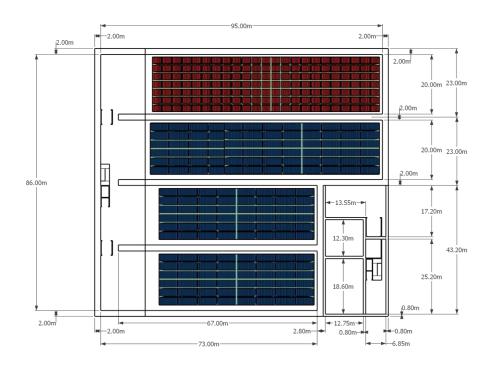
7 m³ 鋼箱及 20 呎半高貨櫃貯存單元平面示意圖
